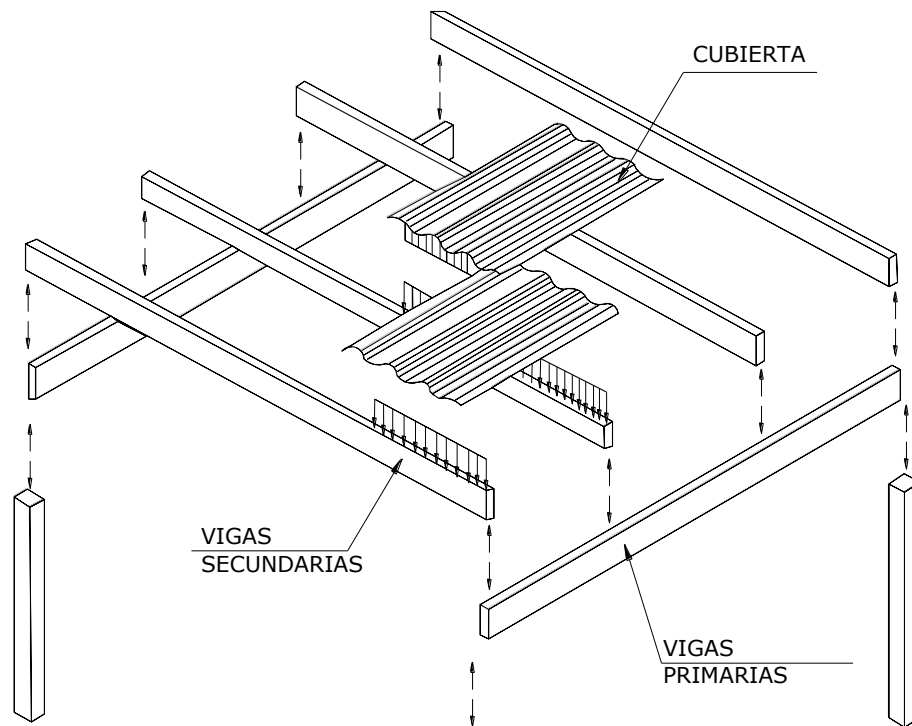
Flujo de cargas gravitacionales en estructuras de techo flexibles
